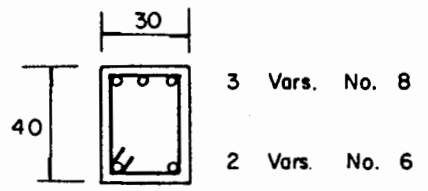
Armado de vigas usando RCDF-87 y Q=2
